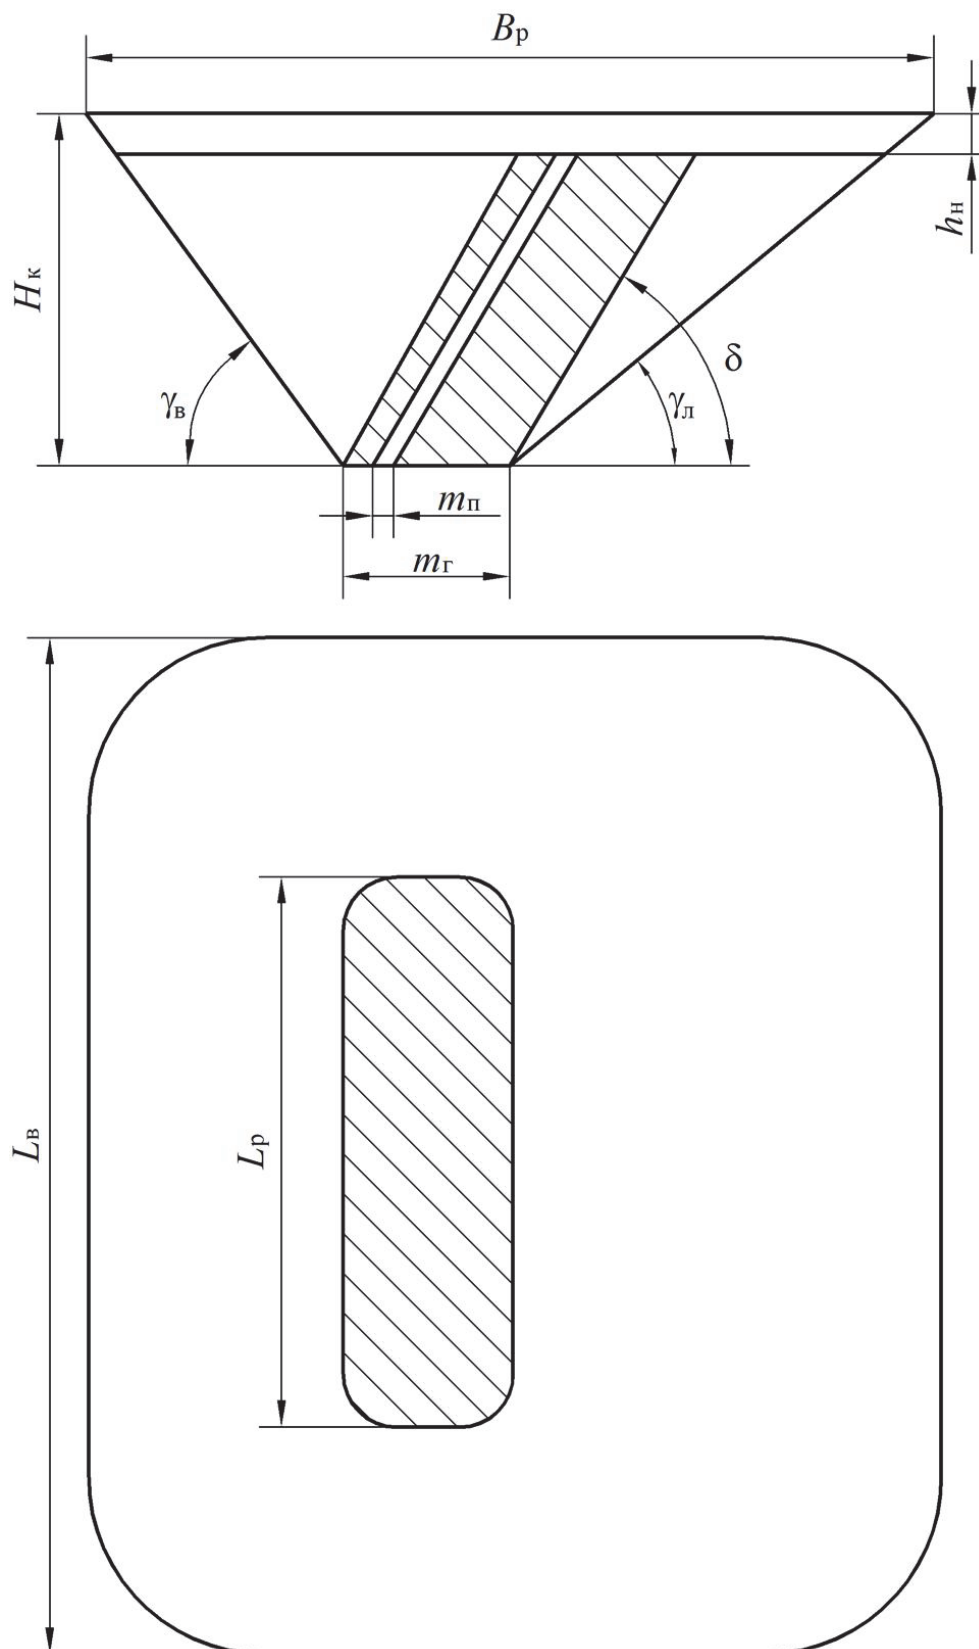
Поперечный разрез и план карьера на конец отработки
